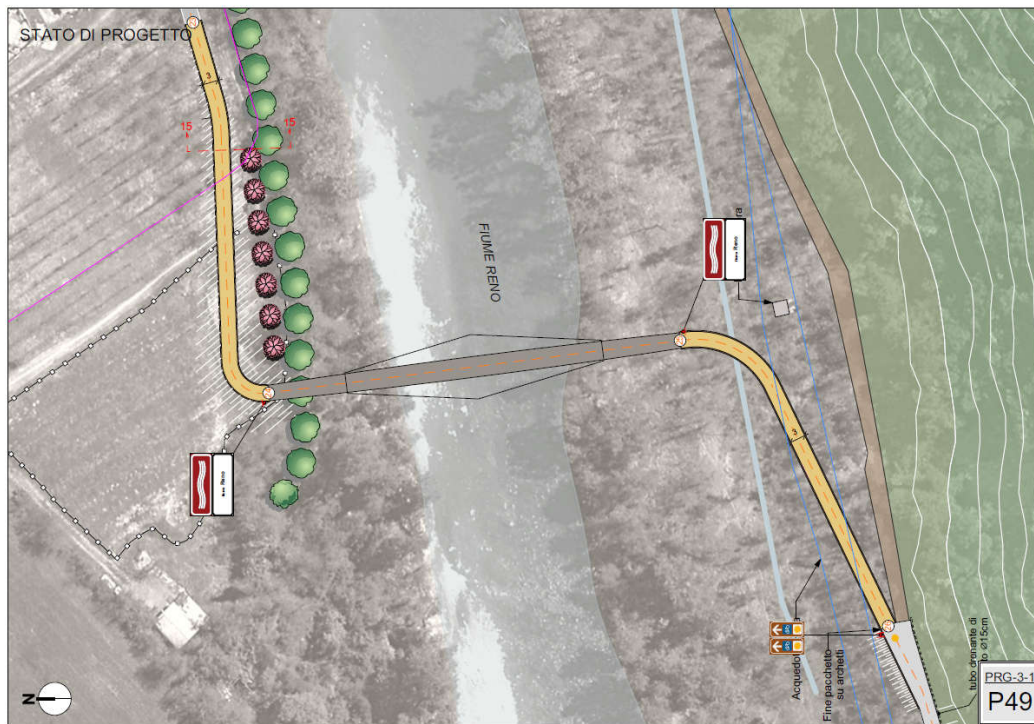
Fiume Reno – vista planimetrica della passerella in acciaio
